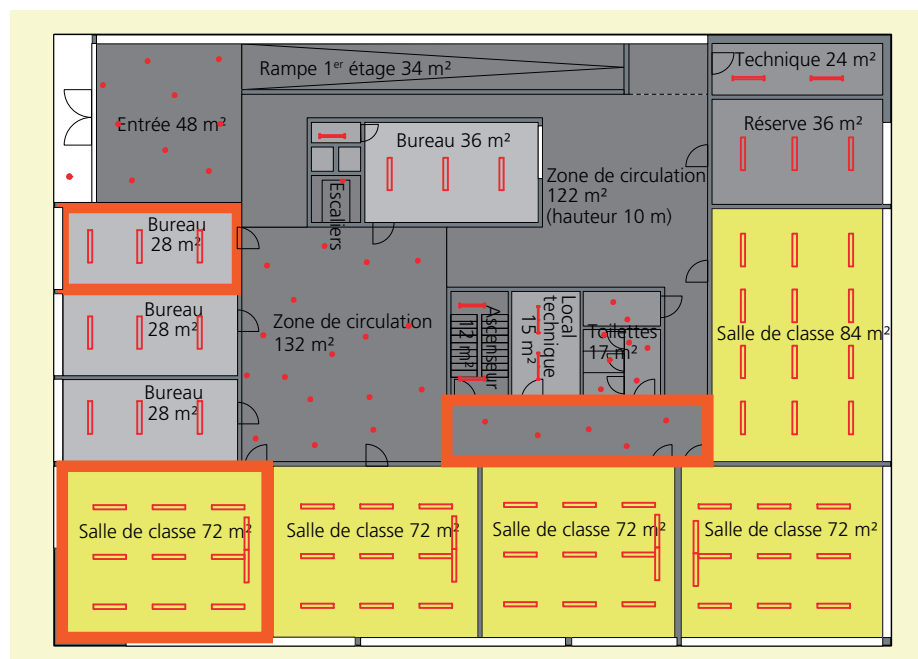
Plan d'un étage caractéristique dans un bâtiment exemple
